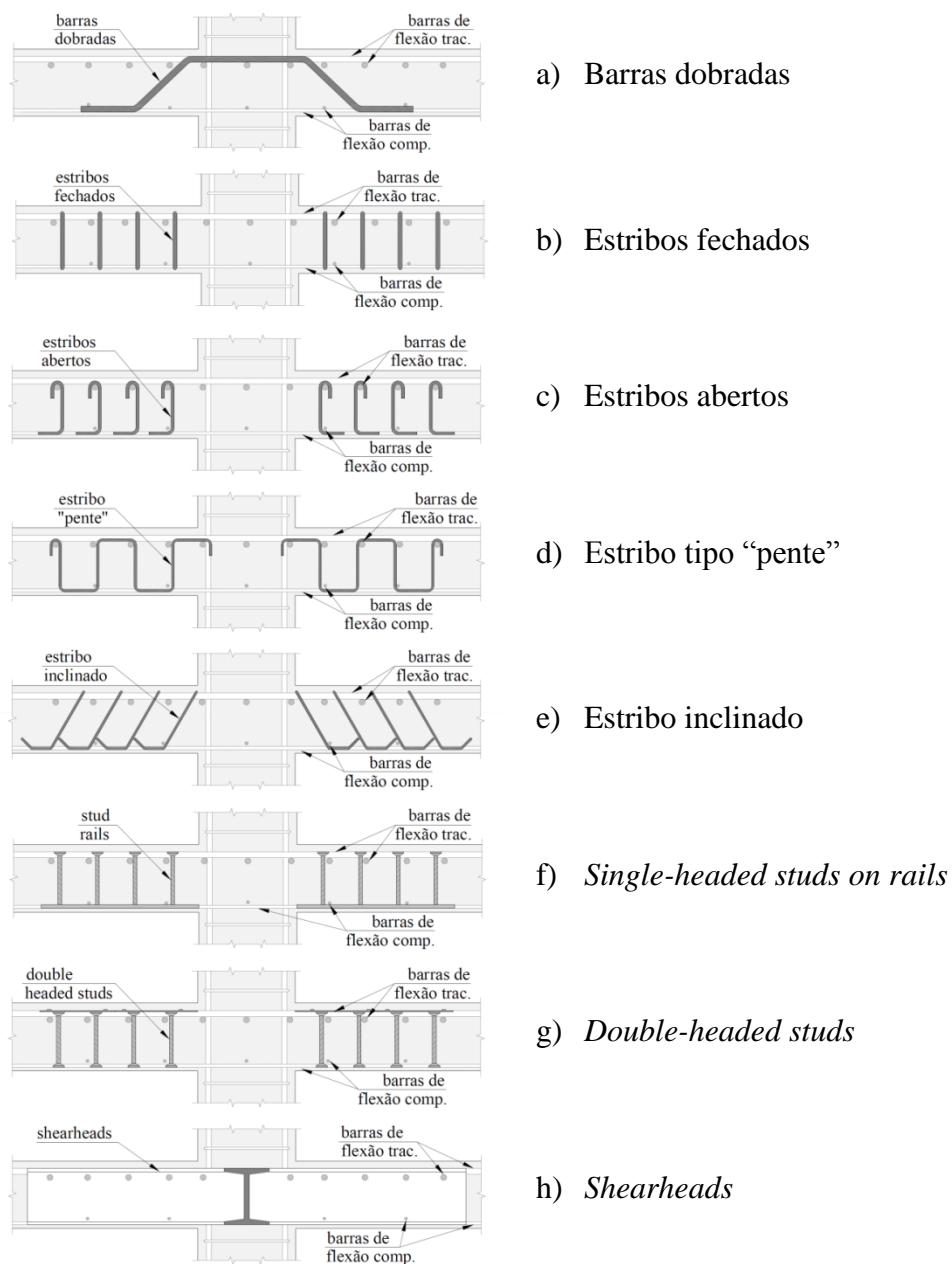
Tipos de armaduras de cisalhamento para lajes lisas [FERREIRA (2010)]
